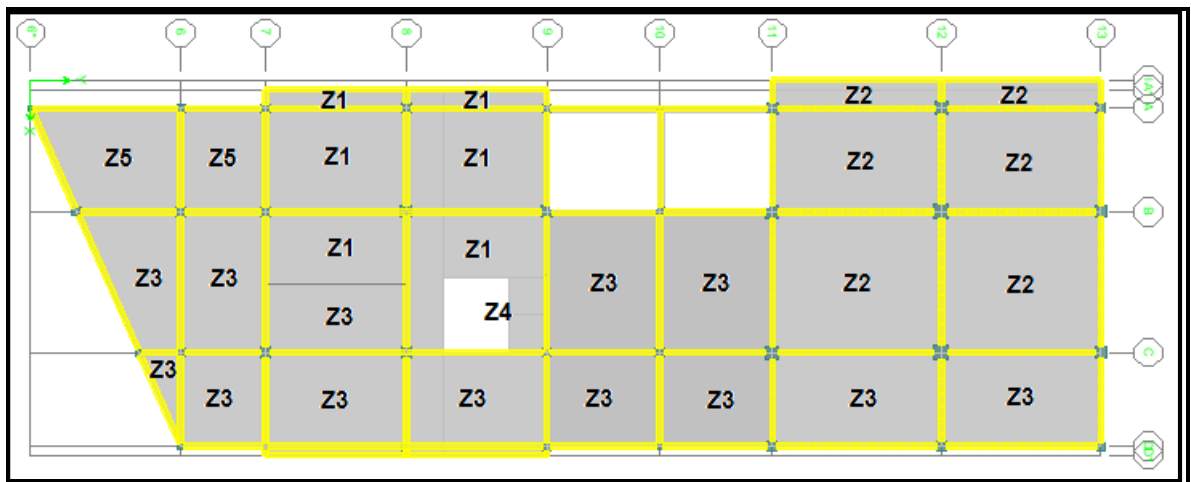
Zonas de la Edificación. Edificio Sur-Oeste (Nivel 1 y 2).
